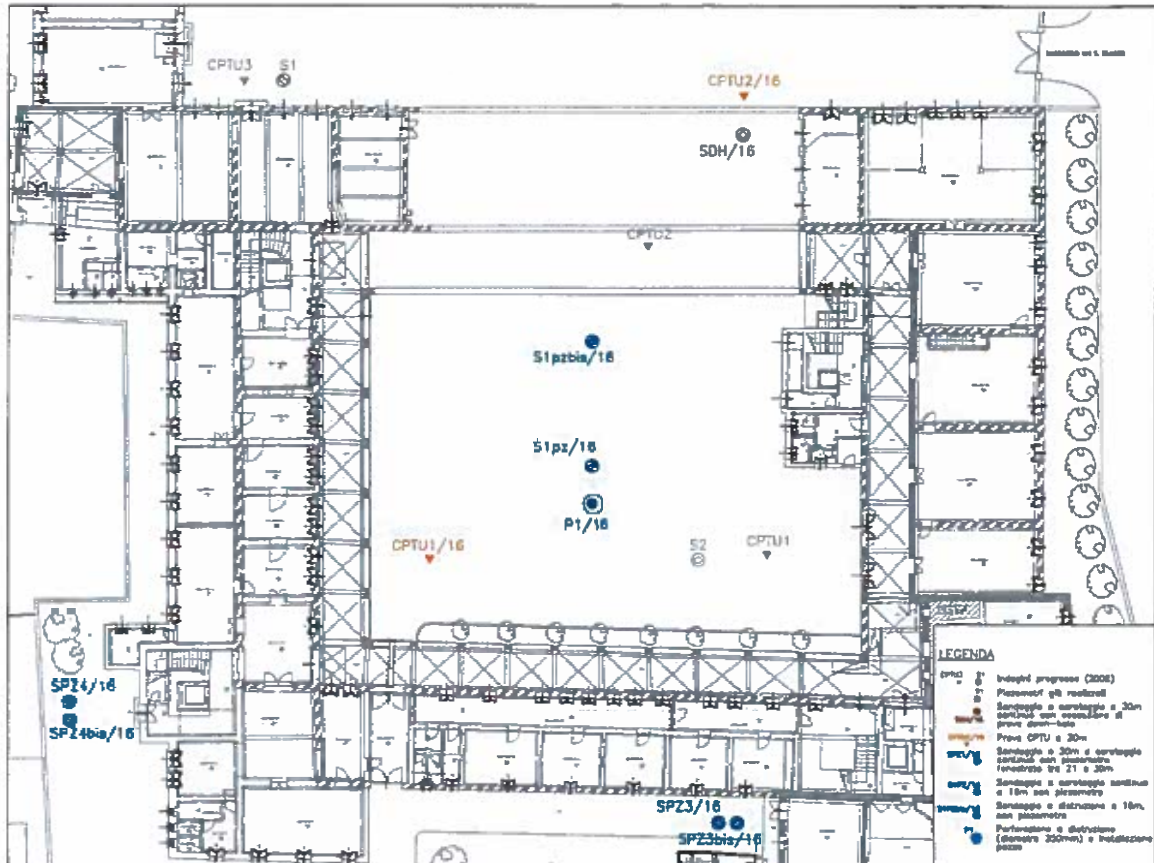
Planimetria dei sito con ubicazione dei sondaggi e delle prove in sito
